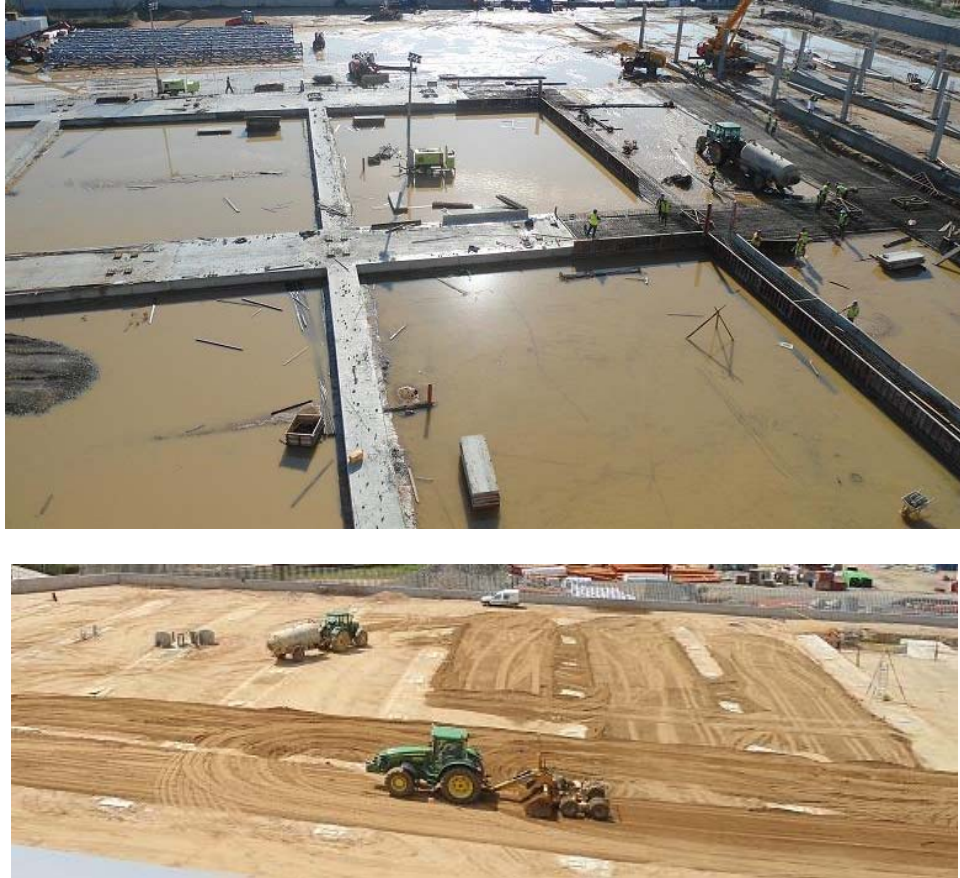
CIMENTACION SUPERFICIAL CON ZAPATA CORRIDA
